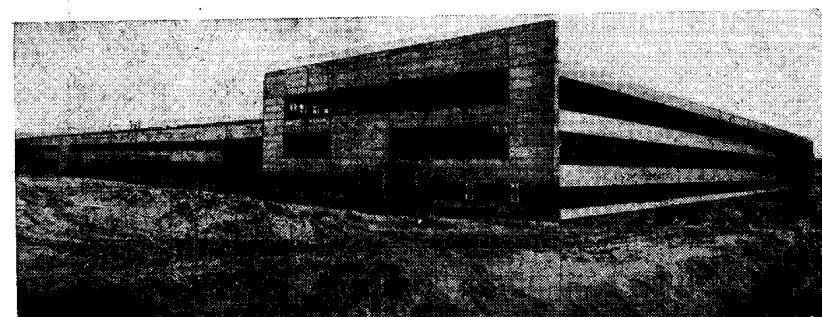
Фрагмент фасада главного корпуса завода алюминиевых конструкций, смонтированного Броварским ЗСК
